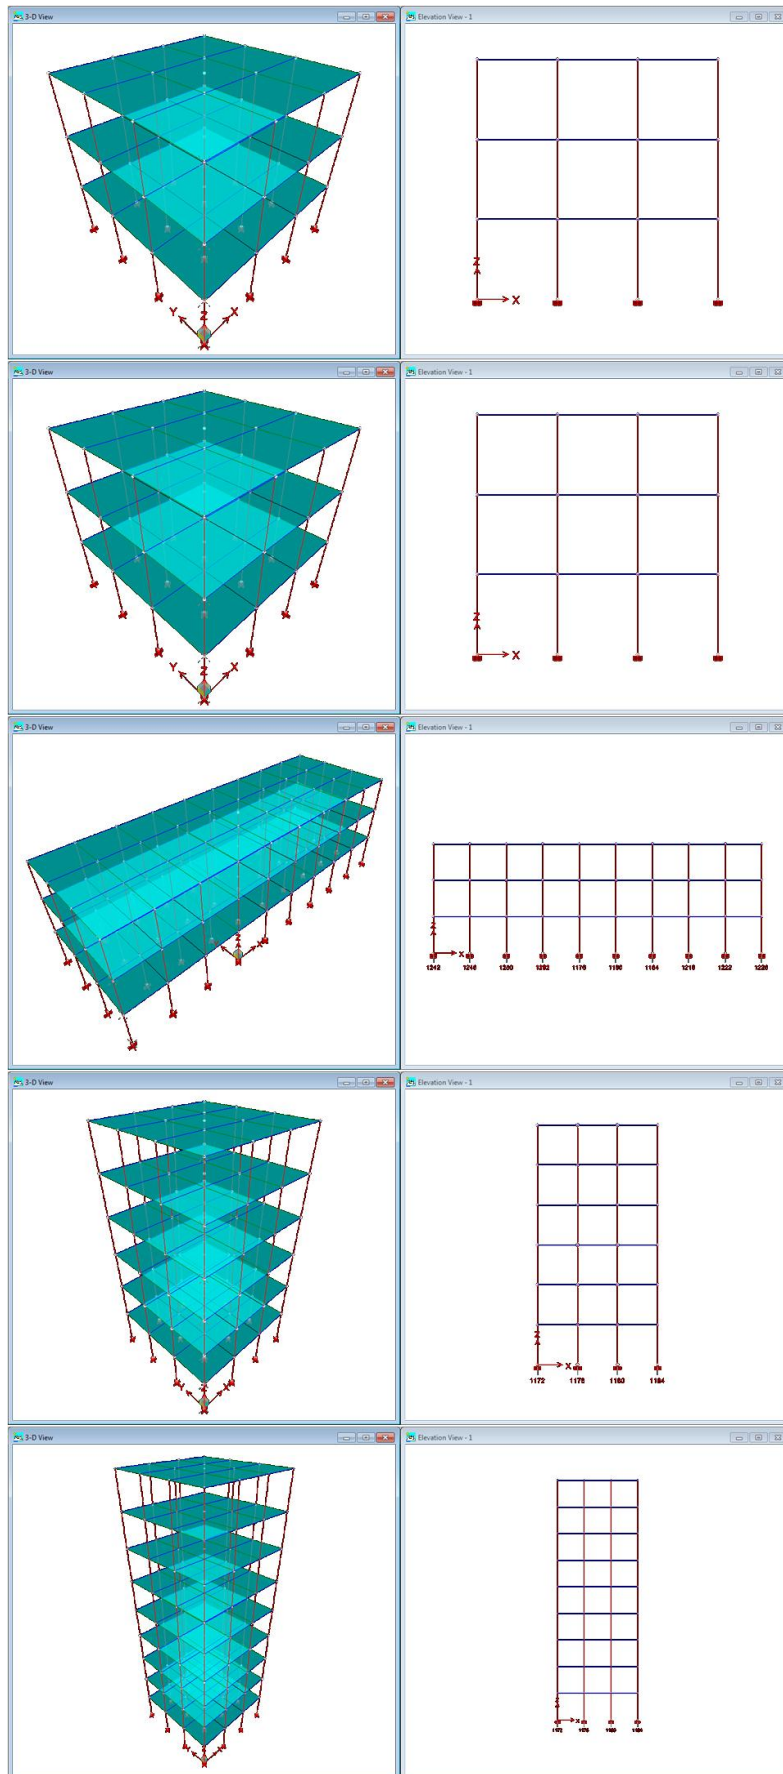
Modèles simulés en structure poteaux-poutres en béton armé sans remplissage. (Crédit photo : Hamoud N.)
